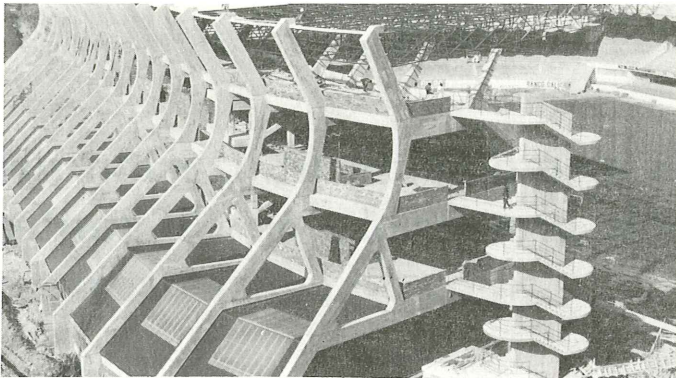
Pórticos estructurales vistos, con la cubierta del polideportivo destacándose en la parte interior y la cubierta espacial ya concluida.
